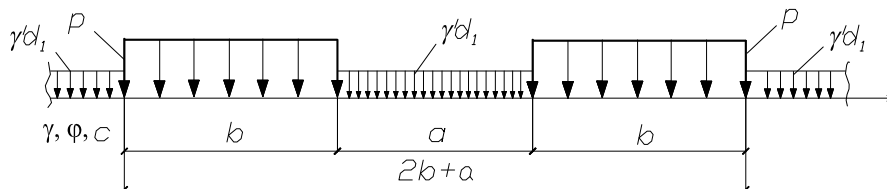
Розрахункова схема взаємодії фундаменту з ґрунтовою основою
